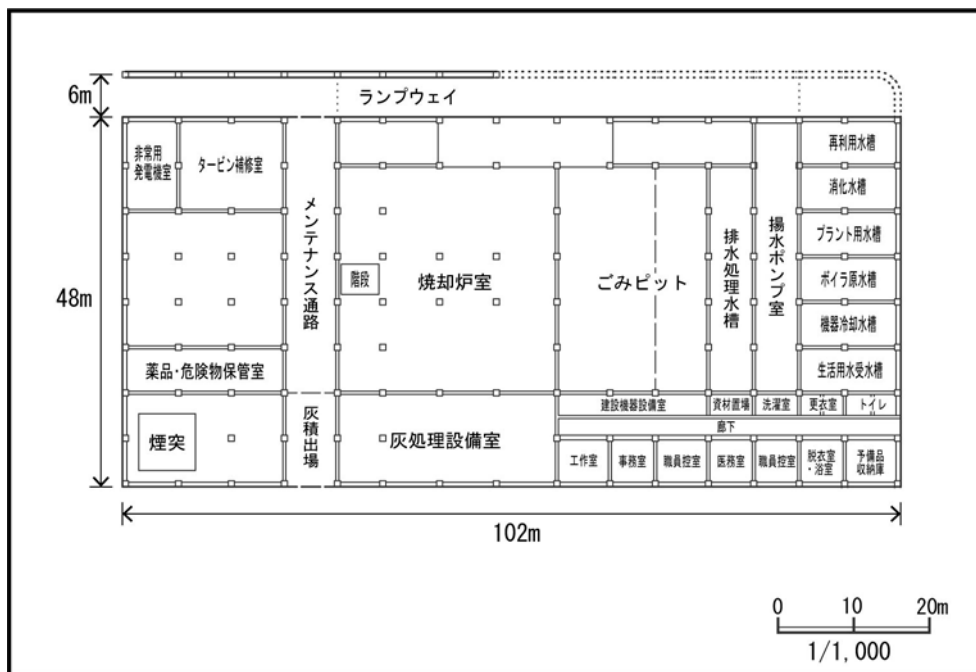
(2) 新施設の平面図（新焼却処理施設 1 階）
